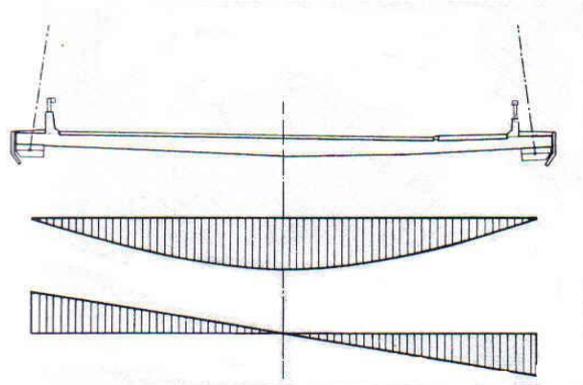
Distribución de fuerzas transversales
